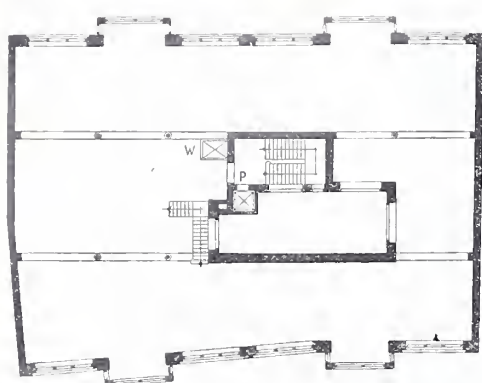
Grundriss vom 1. Stock 1:500.
